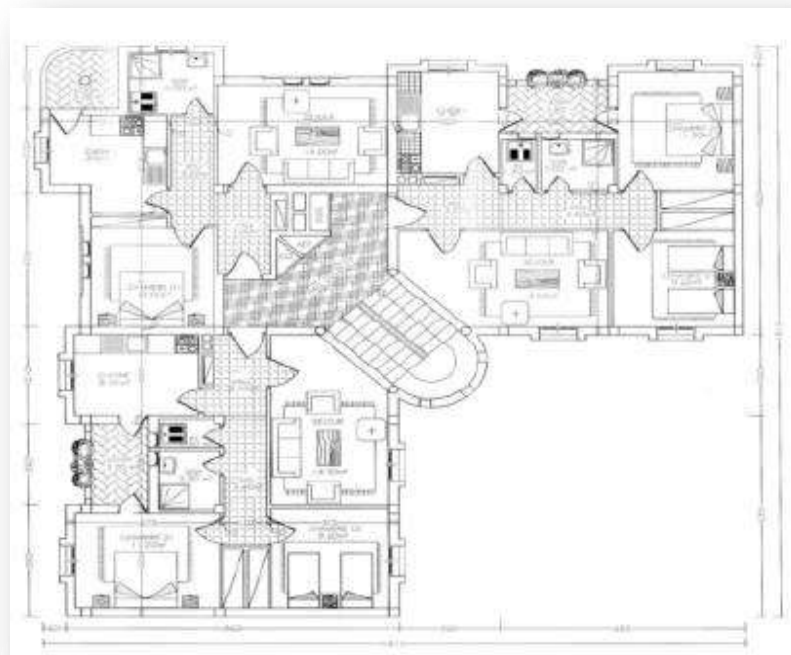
Plan d'architecture 2 F3 + 1F2 , cité136/1200 logements – ville nouvelle de Bellil (Source : OPGI de Laghouat 2009)
